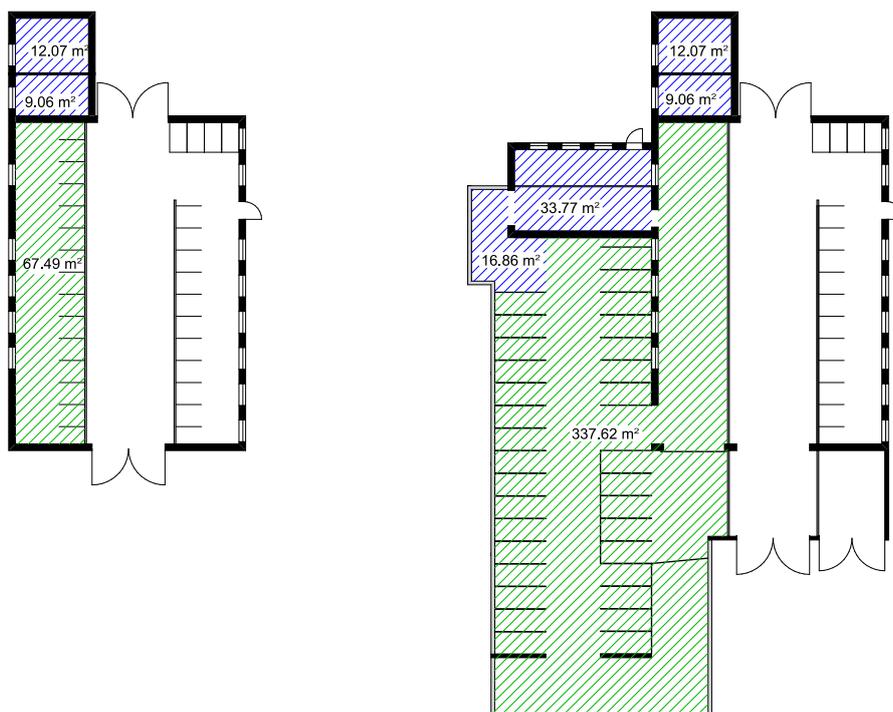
Netto-Grundflächen Betrieb B vor (links) und nach (rechts) dem Umbau, blau schraffiert = Milchkammer/Technik/Nebenräume und Melken, grün schraffiert = Stallbereich Milchkühe
